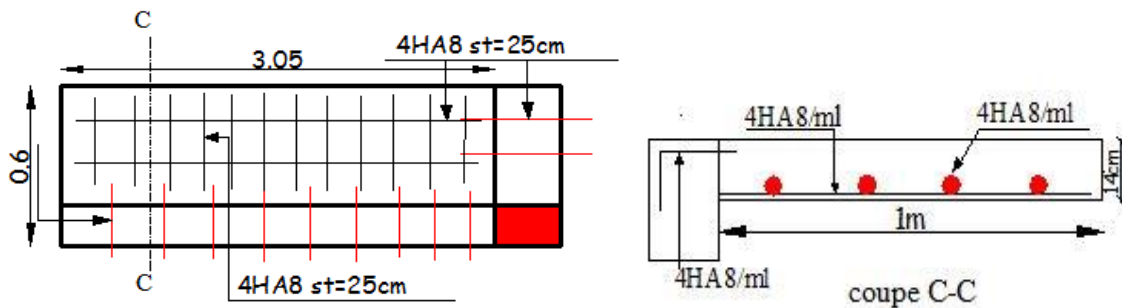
schéma de ferrailage de la dalle 3 et sa coupe C-C.
